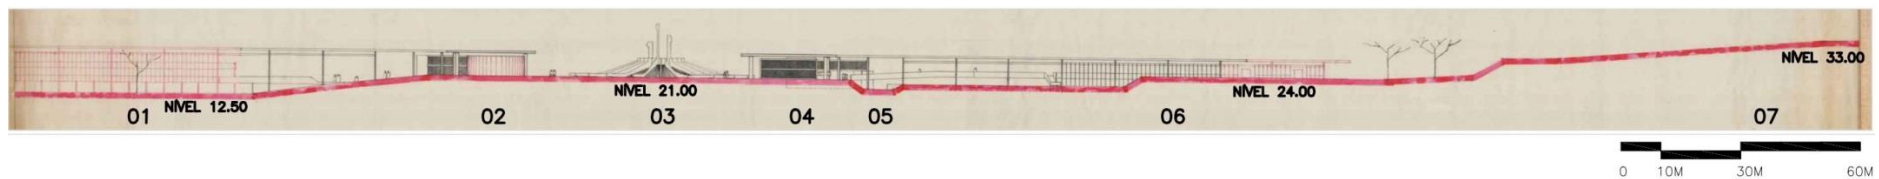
Elevação Sul Plano UMA. Fonte: Pranchas 09 e 10 do Plano de Implantação Imediata – 1º Sub-Etapa Plano UMA – Arquivo digital disponível no COMCAP-UEM.
